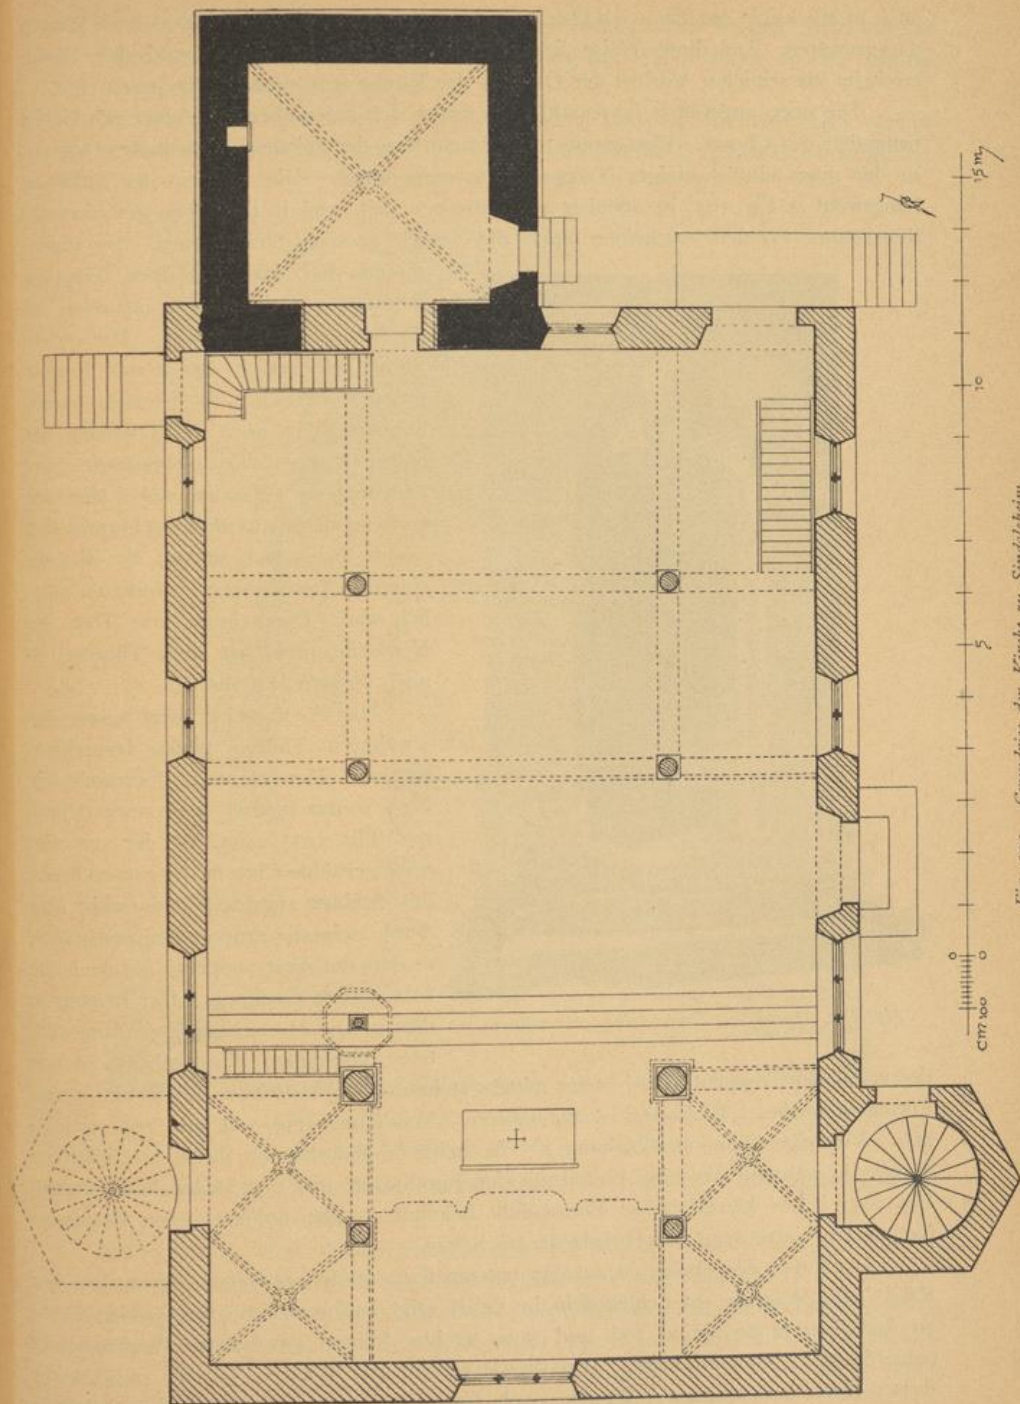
Grundriss der Kirche zu Sindolsheim.
